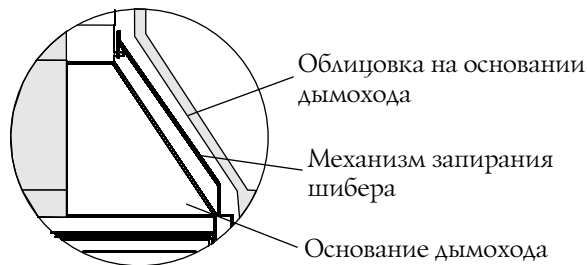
Зазор для свободного движения механизма запертия шибер
